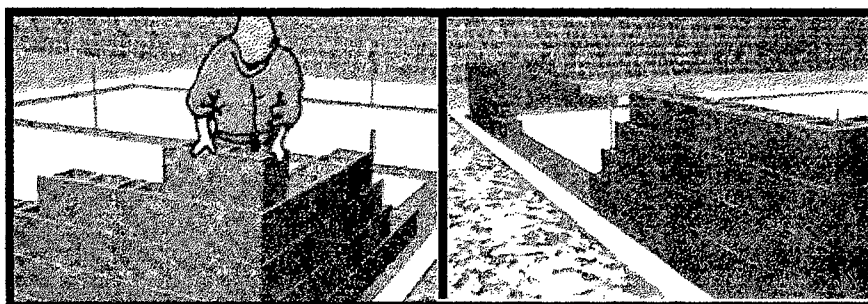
Asentado de bloques (construcción de las maestras).
